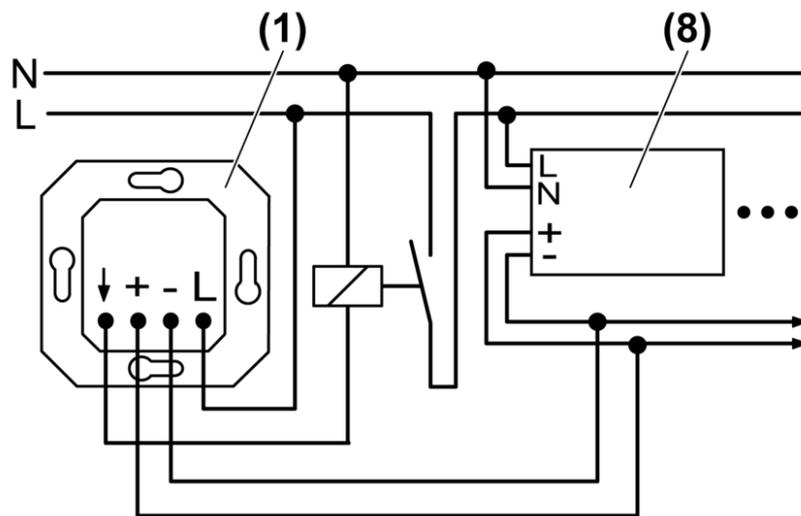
Schema di collegamento del potenziometro con funzione di azionamento e contattore
